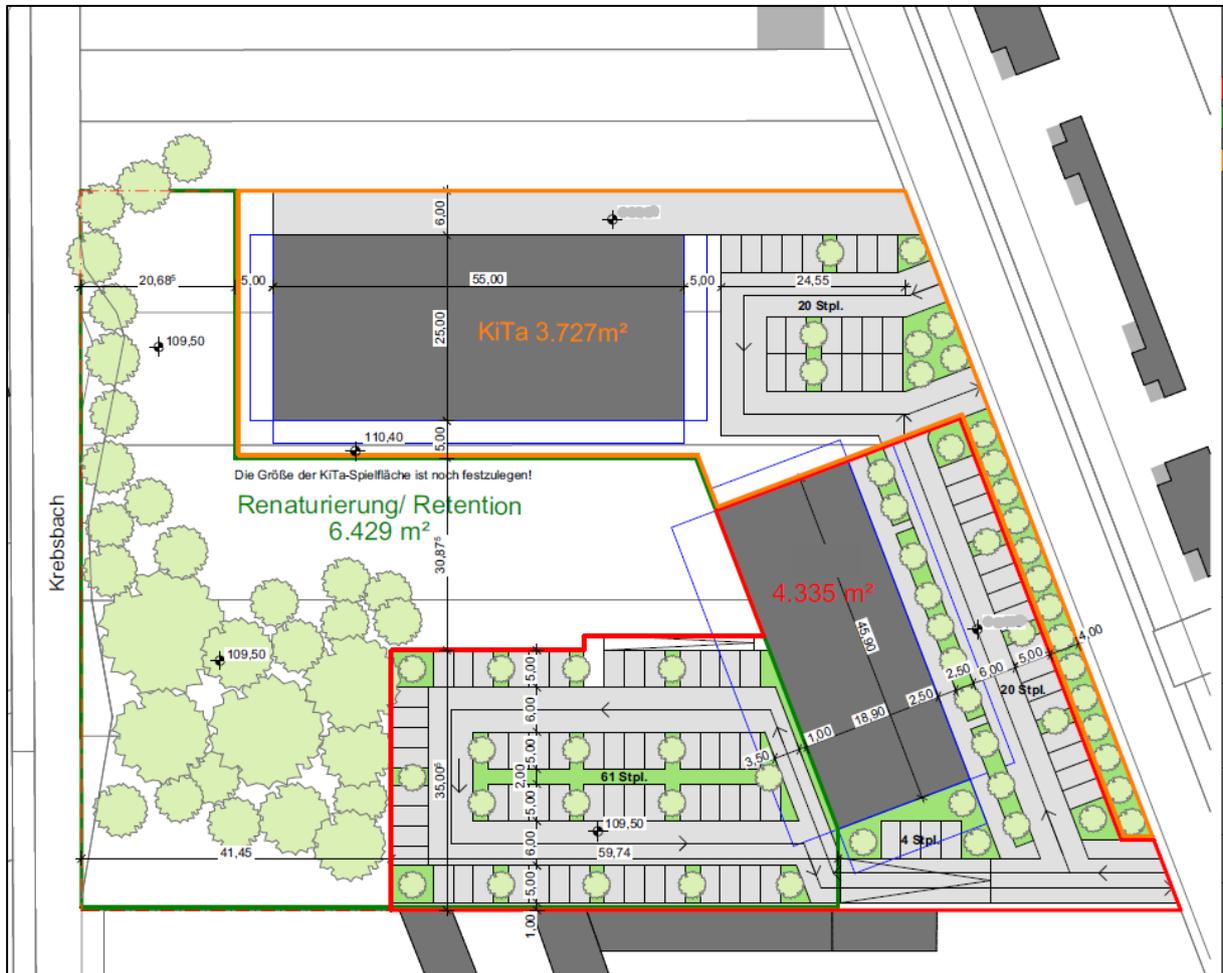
Lageplan der geplanten Baumaßnahme – Variante A
